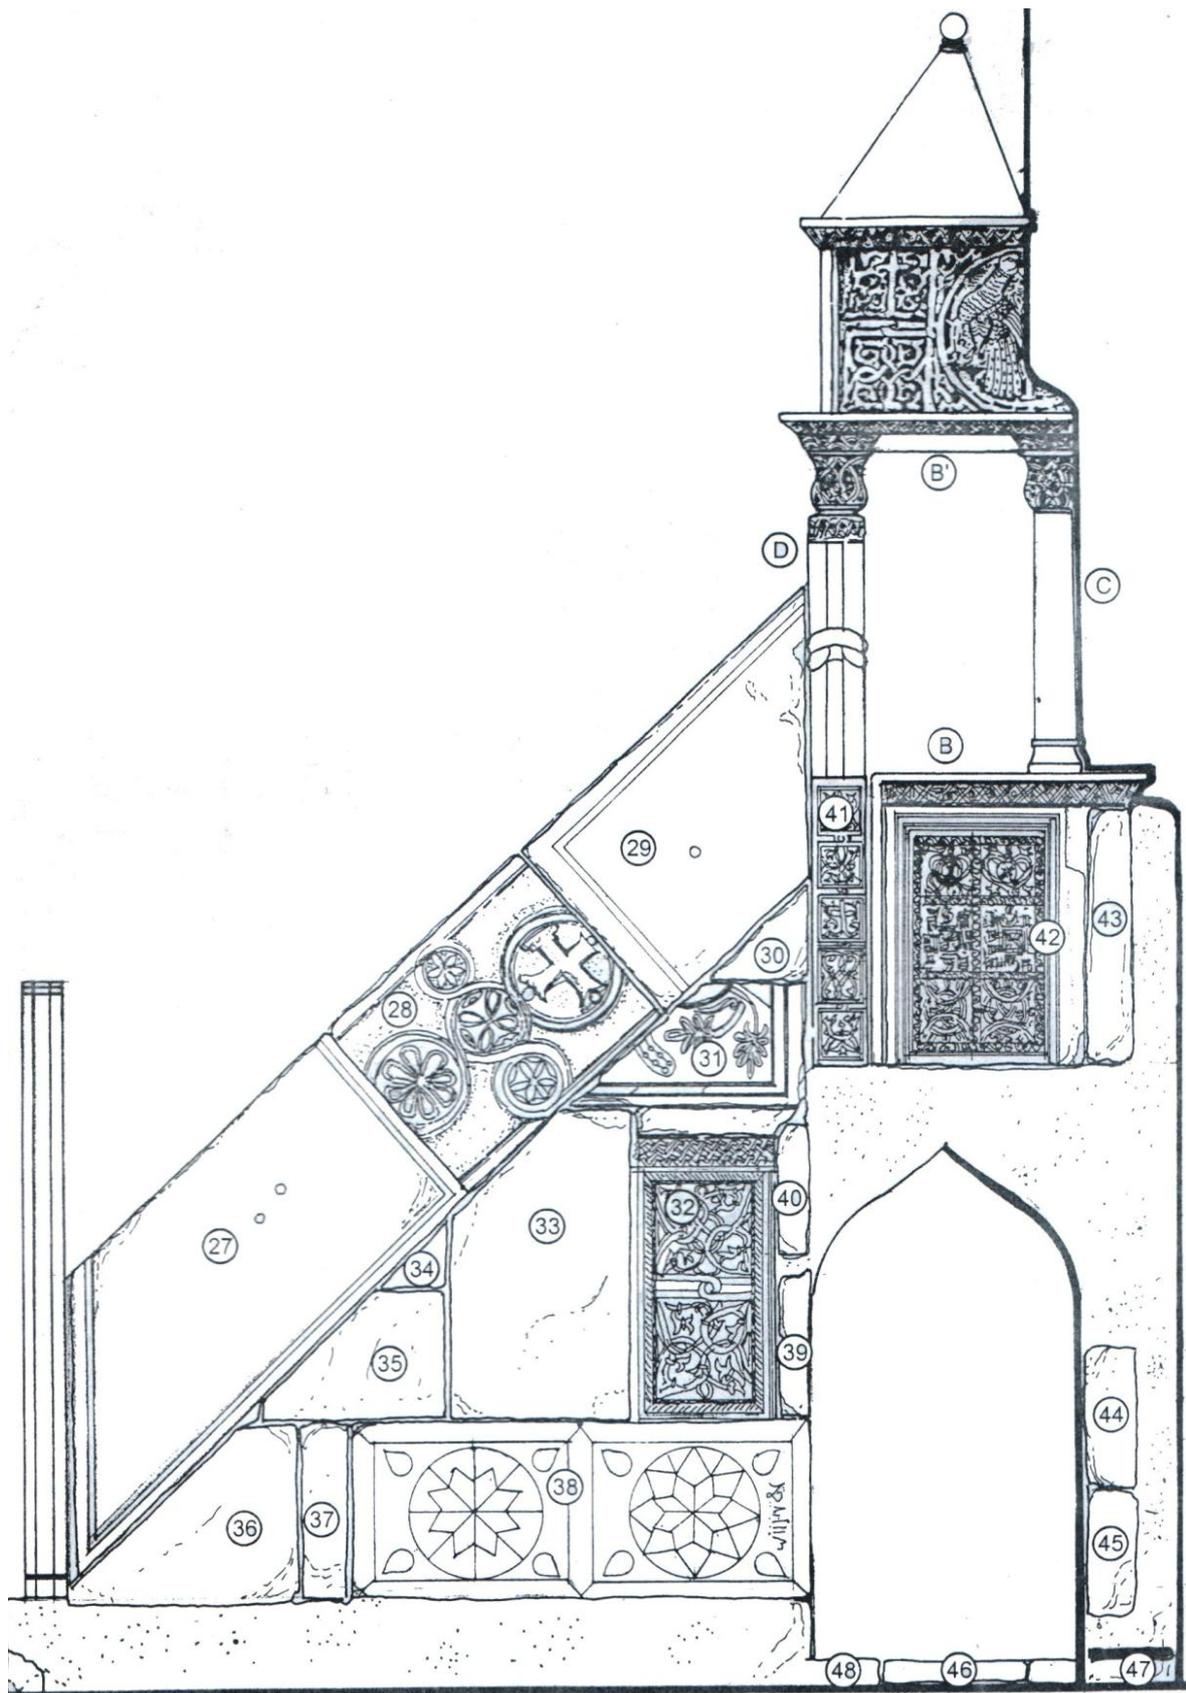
Alzado oeste del mimbar turco de Santa Sofia.
